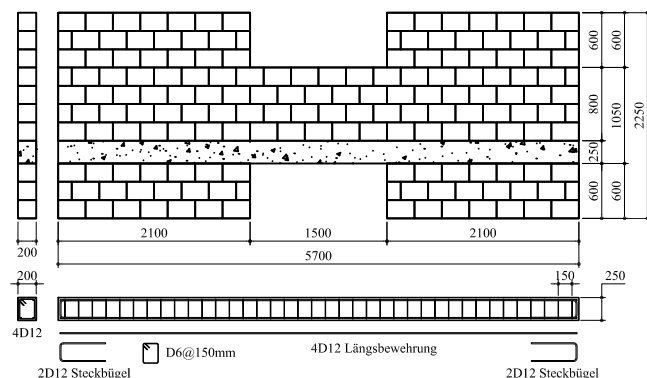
Abmessungen der Versuchskörper und Bewehrungslayout der Stahlbetonbalken (die Längsbewehrung variiert zwischen den Versuchskörpern, siehe Tabelle 1).
